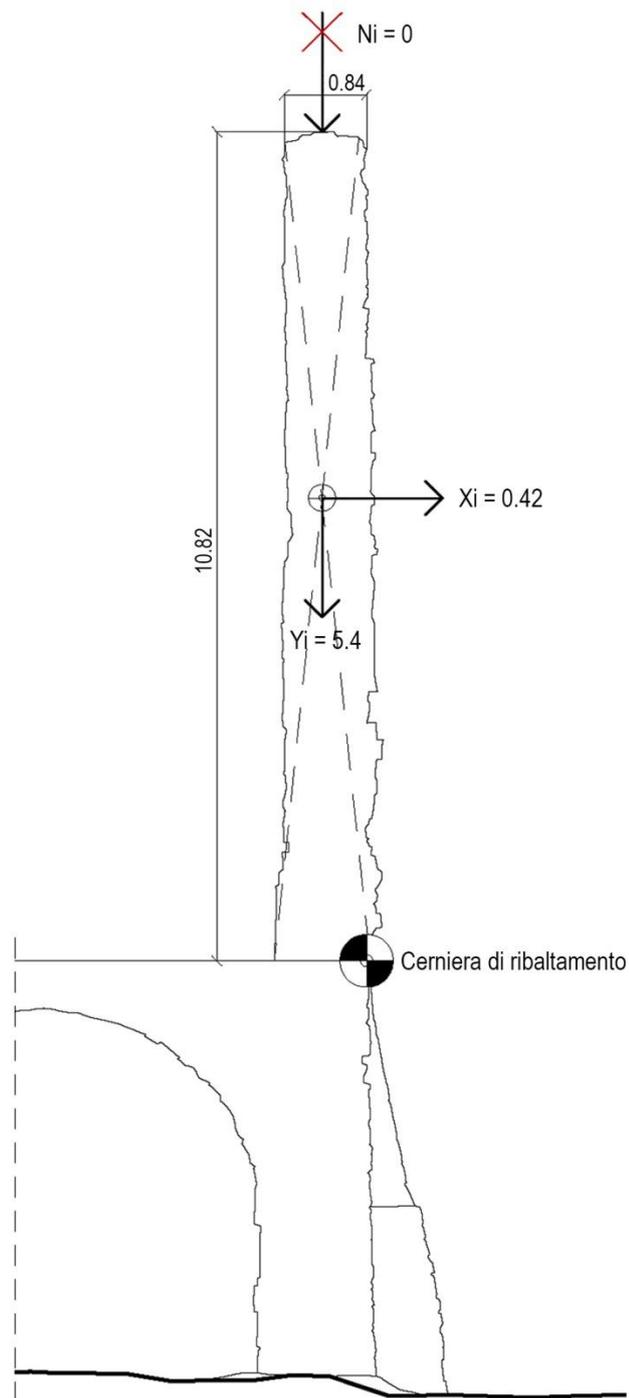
Schema statico prospetto Nord-Ovest
